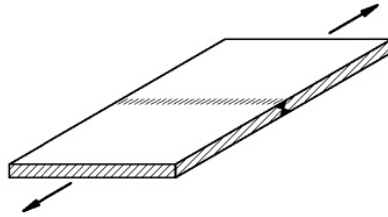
C.5 Soldaduras de la chapa de tablero transversales al carril de circulación sin placa de respaldo metálica
